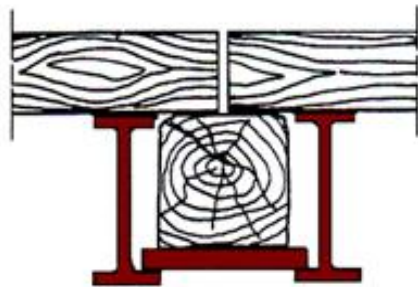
Poutres en bois renforcées avec de l'acier
